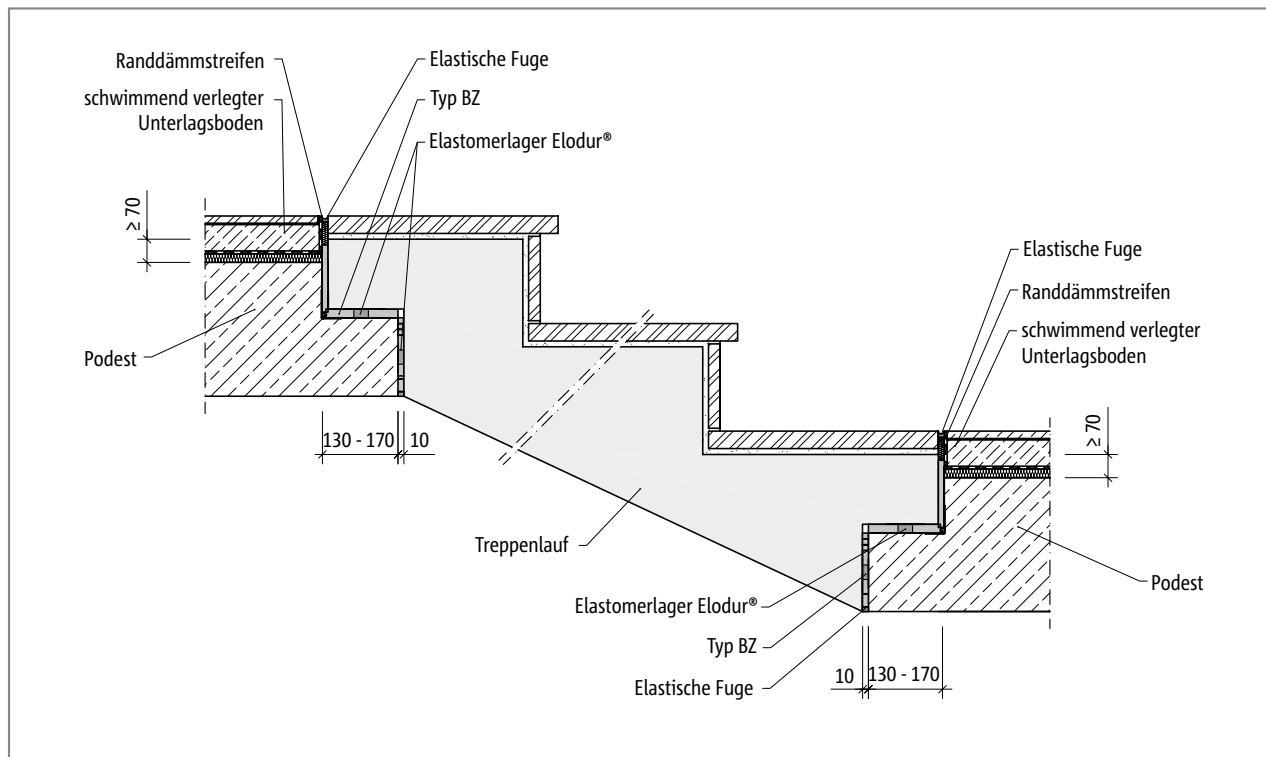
Schöck Tronsole® Typ BZ: Einbauschritt
